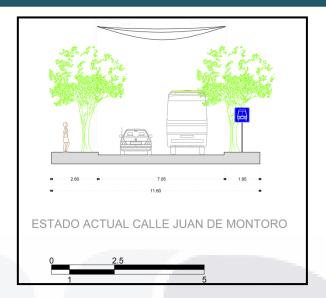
Sección transversal del estado actual de la calle Juan de Montoro
